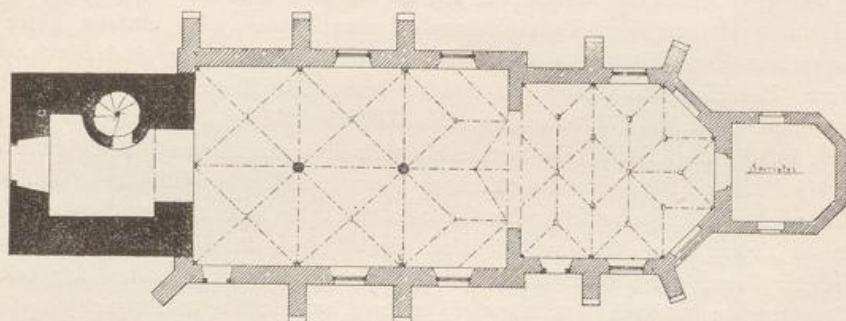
Mudscheid. Kathol. Pfarrkirche. Grundriss.
